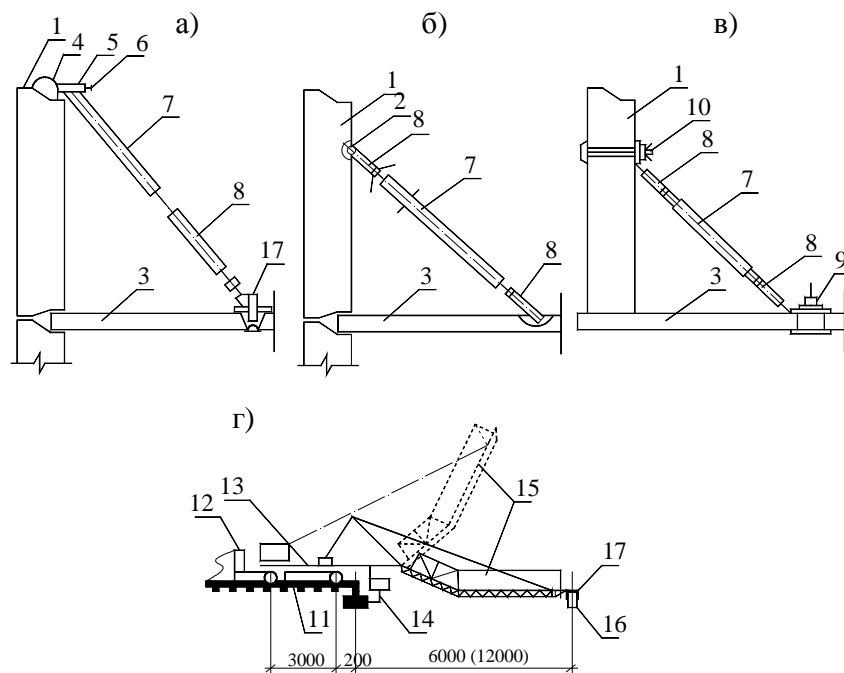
Типи монтажного обладнання для монтажу:
